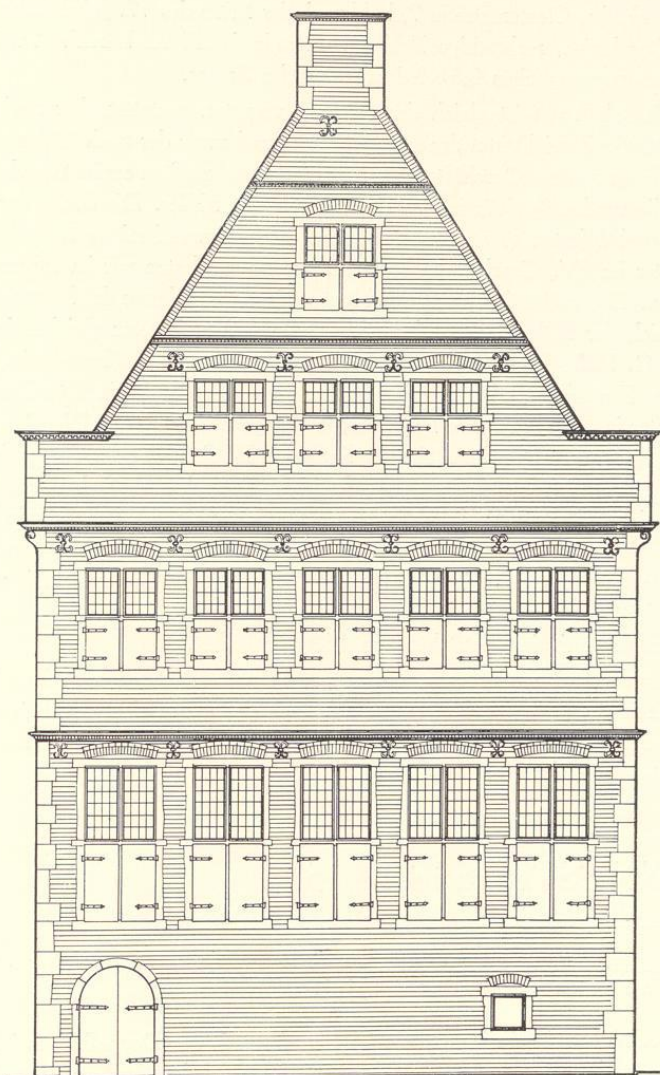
Rekonstruktion der Rück(West-)front des Hauses Ägidistraße 60
